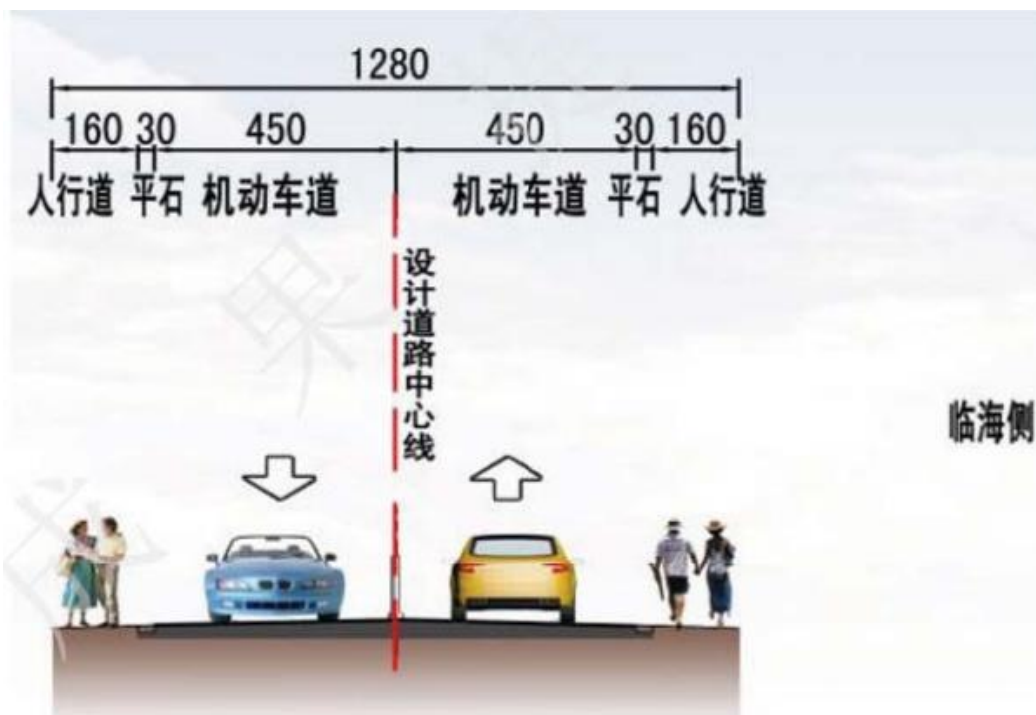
原西大堤(神州宾馆~黄石嘴)段现状横断面布置图
